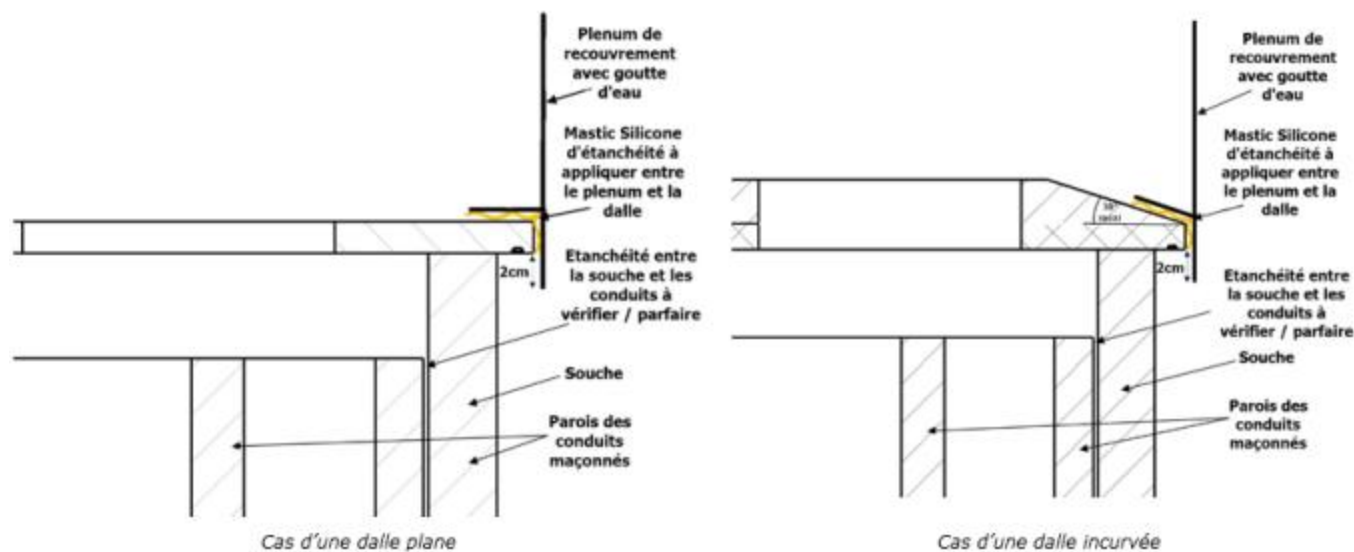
Coupes verticales d'un plenum de recouvrement avec goutte d'eau sur dalle conservée
